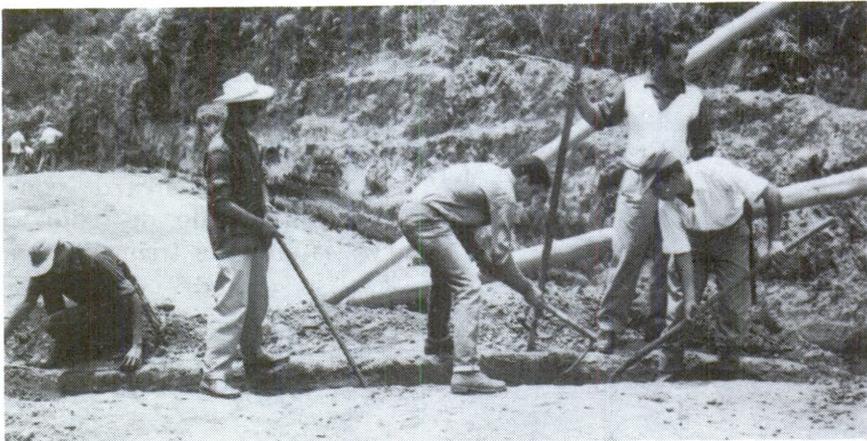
Construcción de drenaje transversal en caminos forestales.
